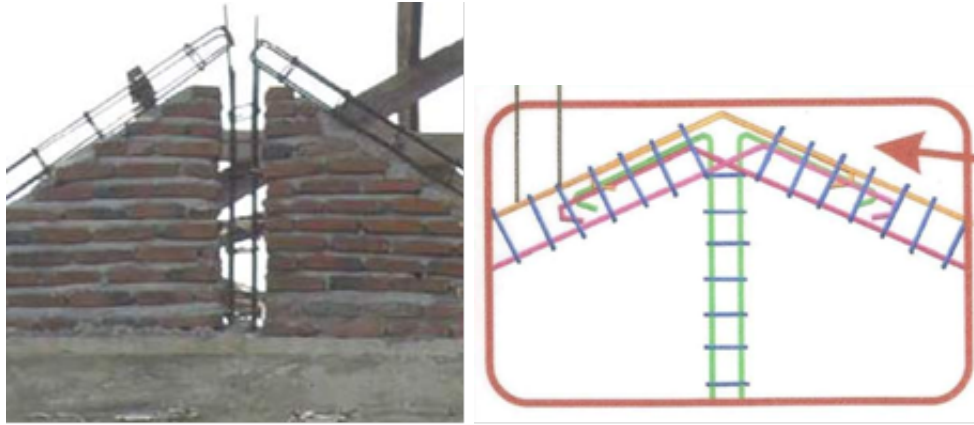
Detalle del refuerzo longitudinal en el encuentro de las cadenas inclinadas. Izq: Mala ejecución. Der: Buena ejecución (BuildChange, 2006)
